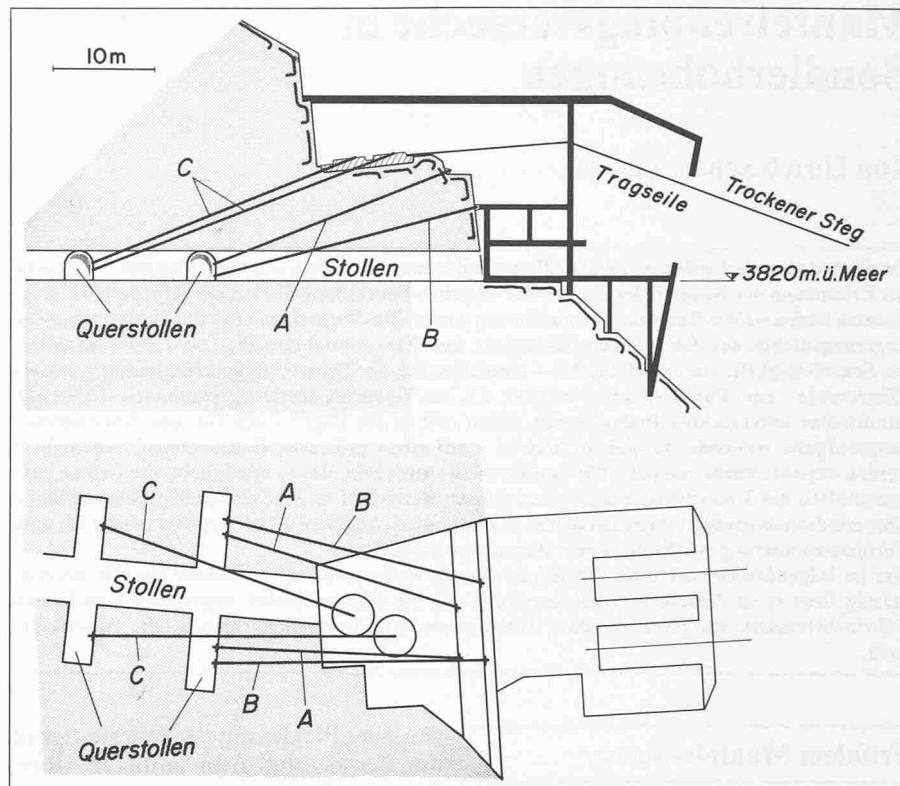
Bergstation, Verankerungen. Auftriss (oben), Grundriss (unten)
